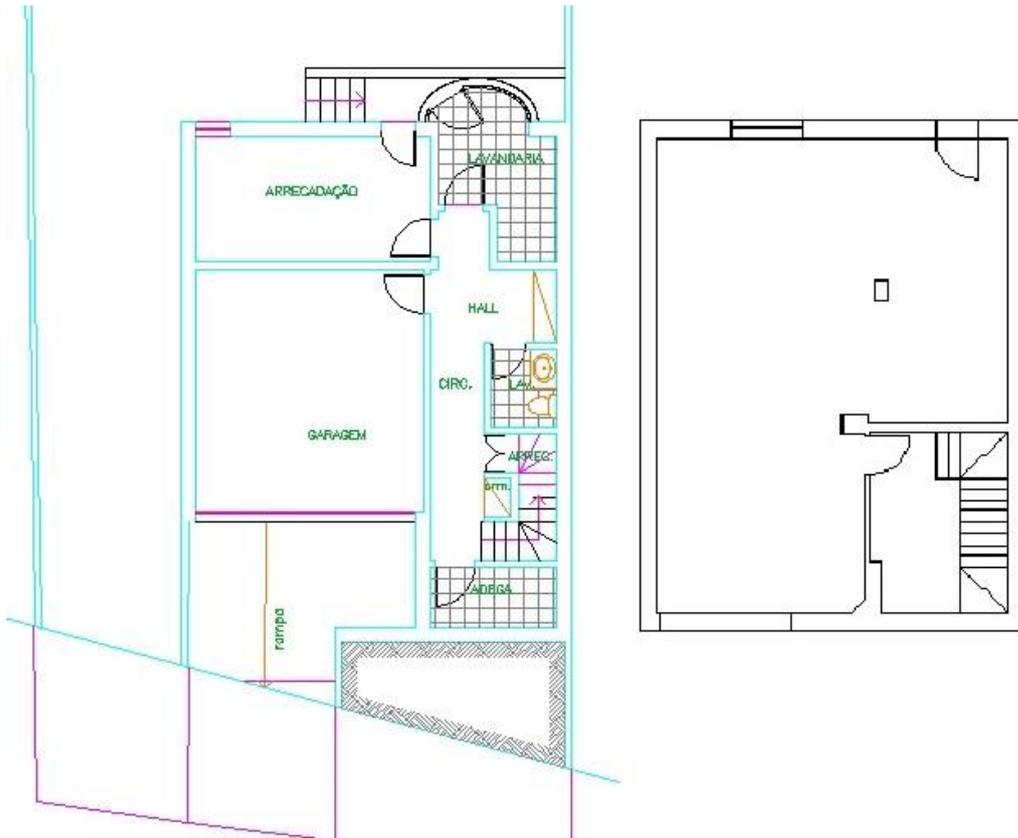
Planta da cave do Lote 3 - comparação pré e pós intervenção
